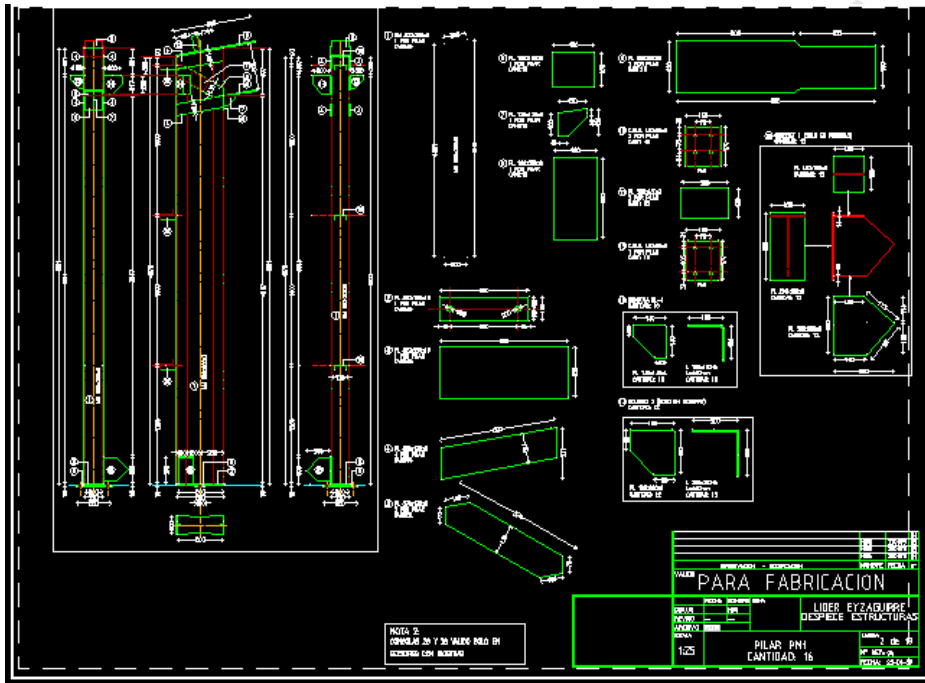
Plano de cantidades de acero. Planos de casas-Planos de construcción (2019).
